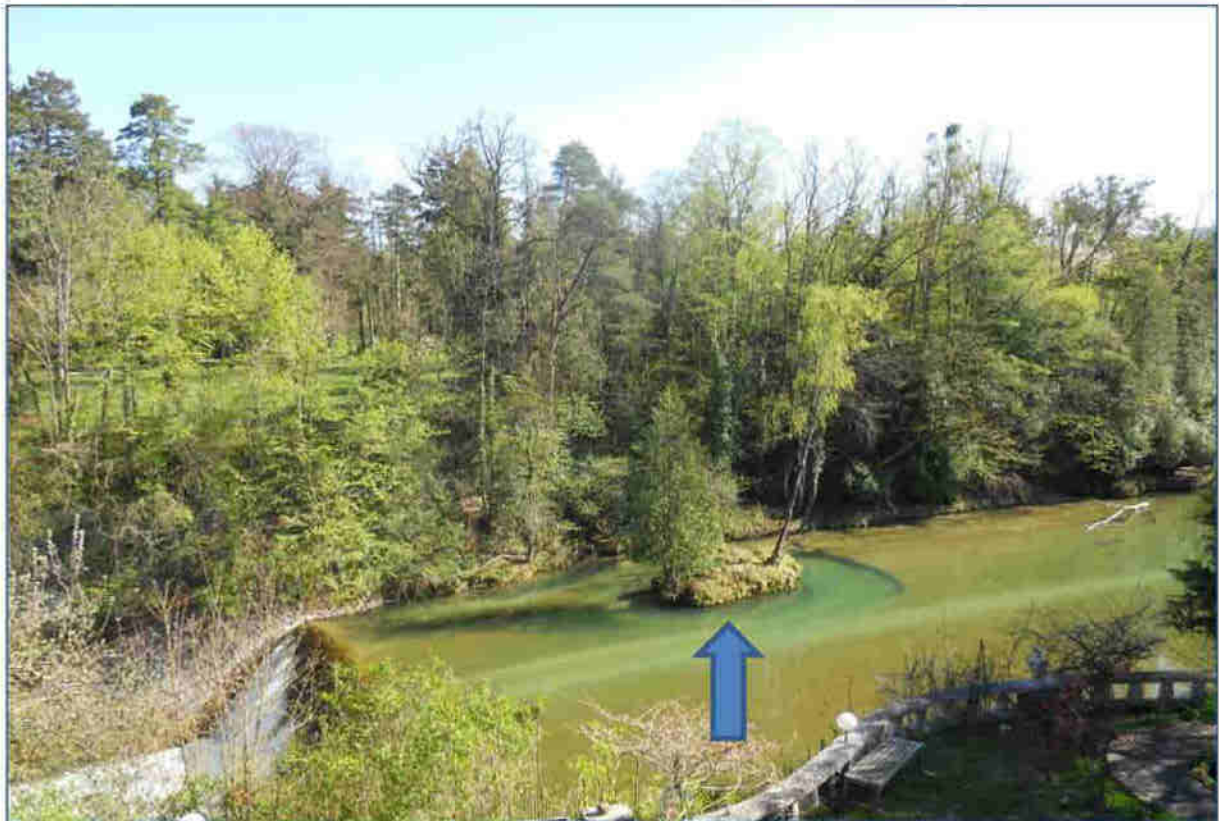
Blick auf das Oberwasser mit baumbestandener, landschaftsprägender Felsinsel (Pfeil) vor Baubeginn. Sehr gut erkennbar ist die Kolkbildung vor der Insel, die dem gleichförmigen Stauraum Struktur gibt und für Wasserorganismen, insbesondere Fische, ein bedeutsames Lebensraumangebot darstellt.
